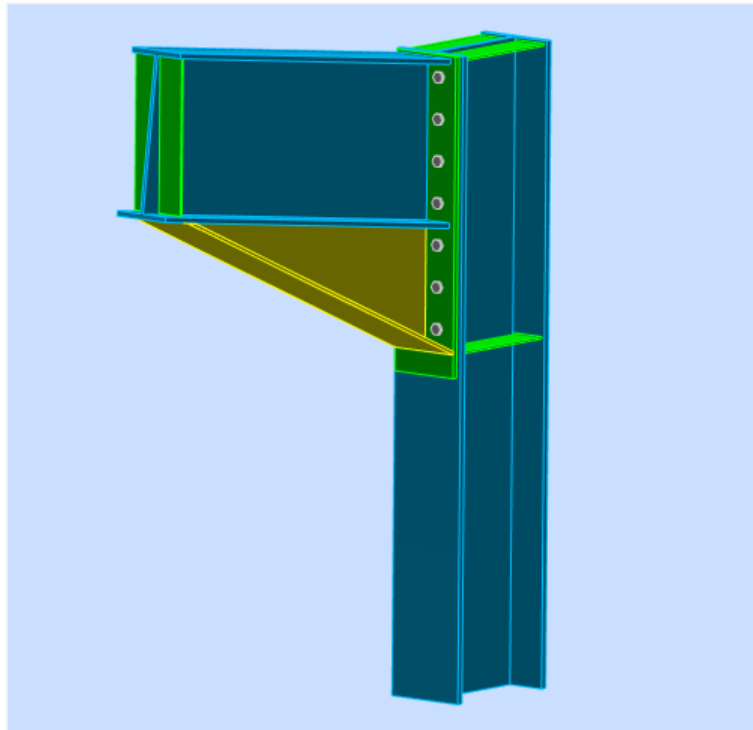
Vue 3D de l'assemblage poteau-traverse (HEA 500–IPE 600)
